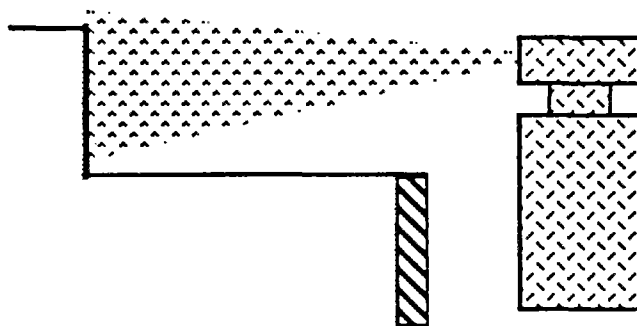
L'excavation se fait sur 12 cm de hauteur et 20 cm de profondeur.
